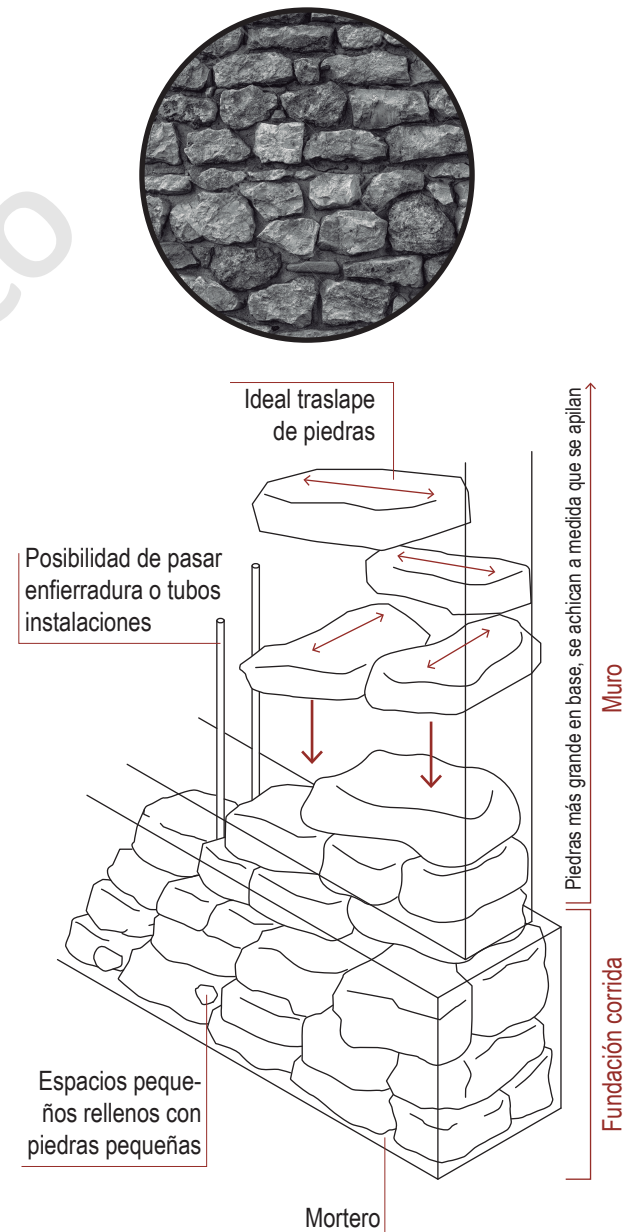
esquemas mampostería piedra. Elaboración propia.
